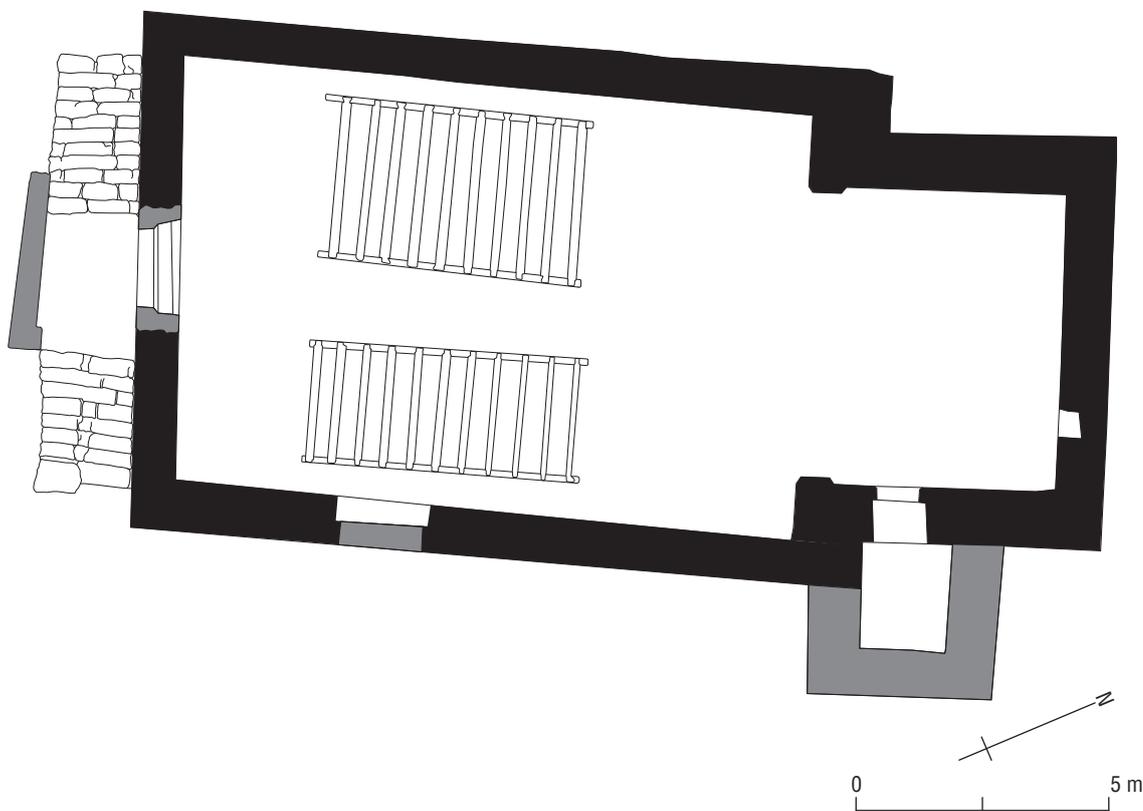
Rhäzüns, Sogn Gieri. 2019. Grundriss der Kirche mit Veränderungen 14.–16. Jahrhundert. Mst. 1:150.
